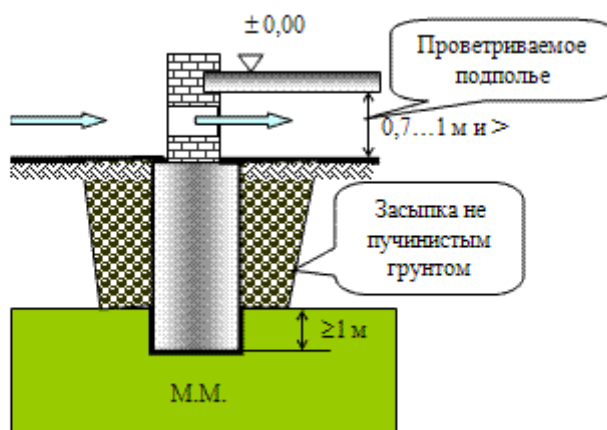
Схема устройства фундамента на мерзлых грунтах по первому принципу строительства.
